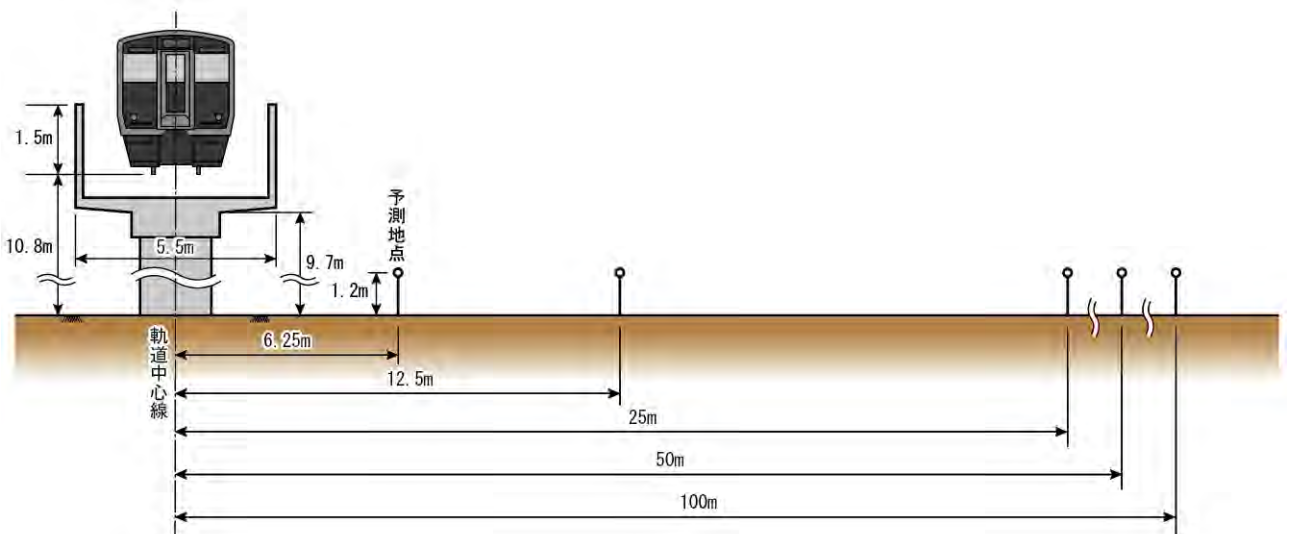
(3) 鉄道騒音の予測断面 (S-3)
